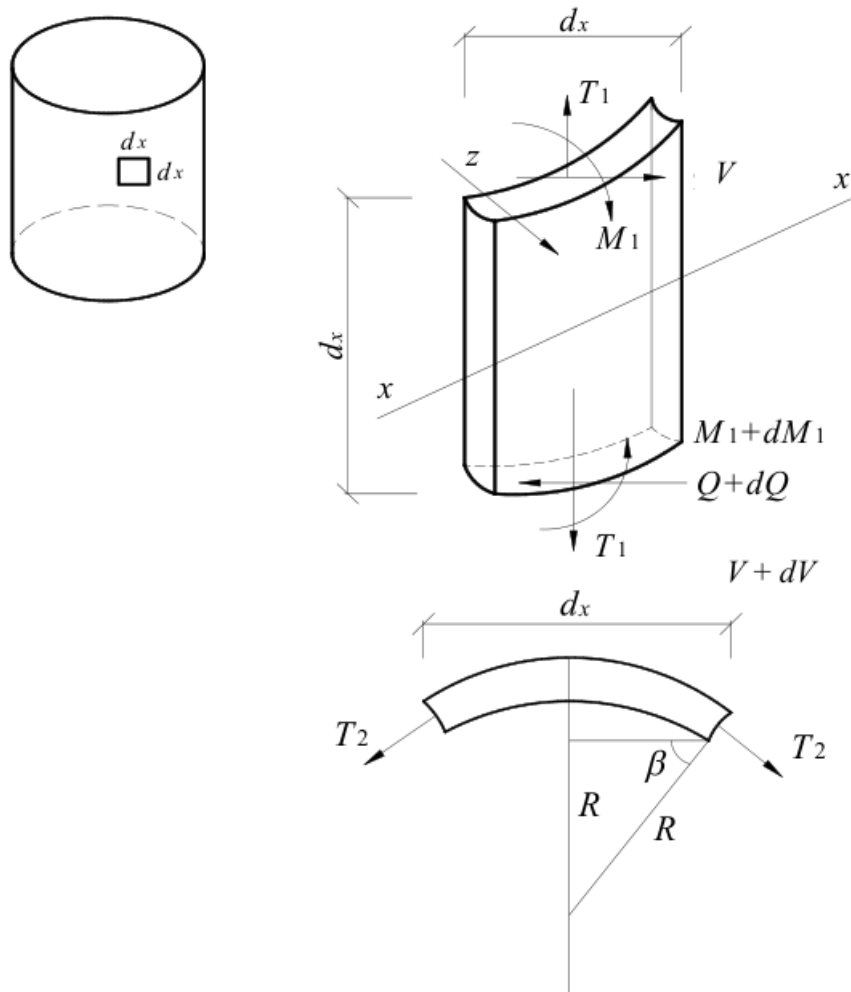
Розрахункова схема зусиль елементарного об'єму стінки резервуара
